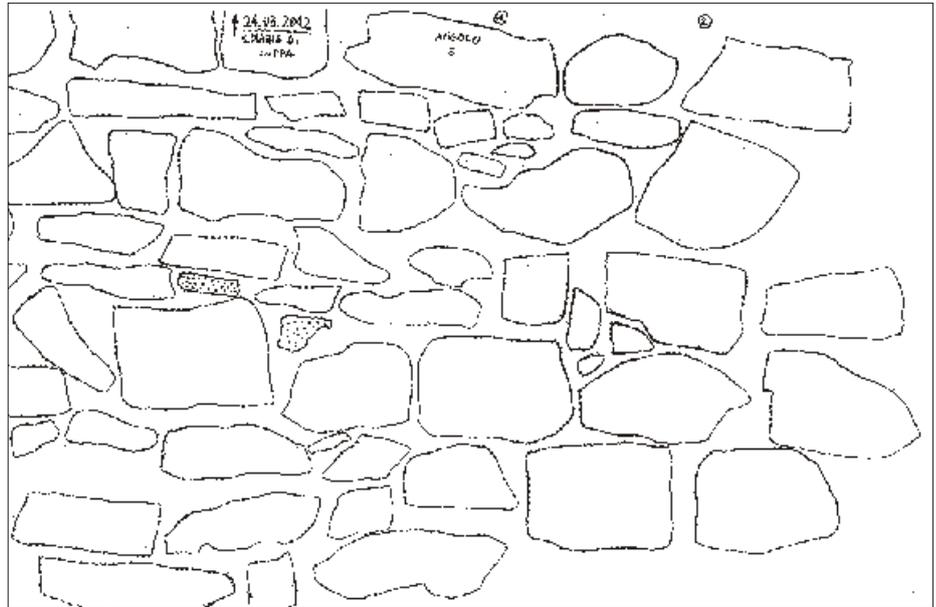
Rilievo dell'estremità est del muro meridionale (pm3 nella planimetria), le parti puntinate indicano i frammenti di laterizio usati come zeppe.
